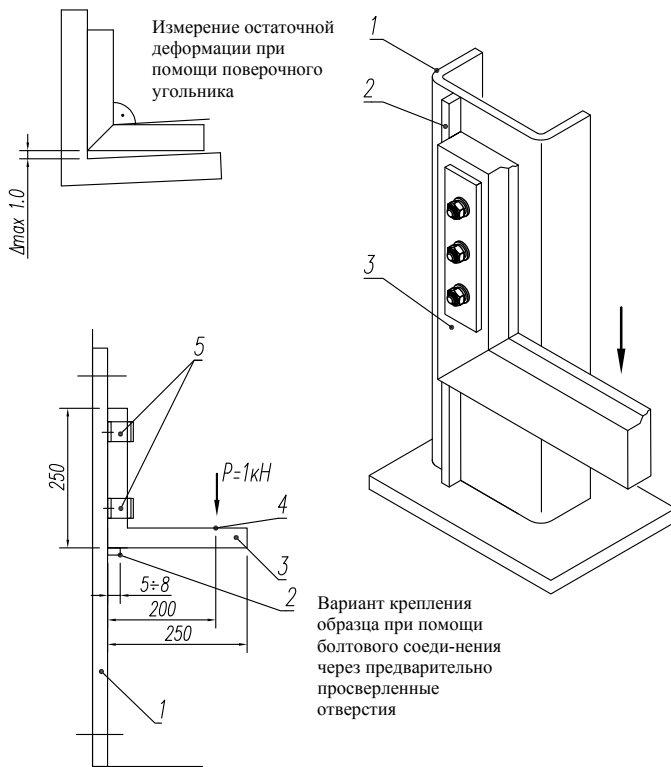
Схема лабораторных испытаний угловых соединений створок и коробок
